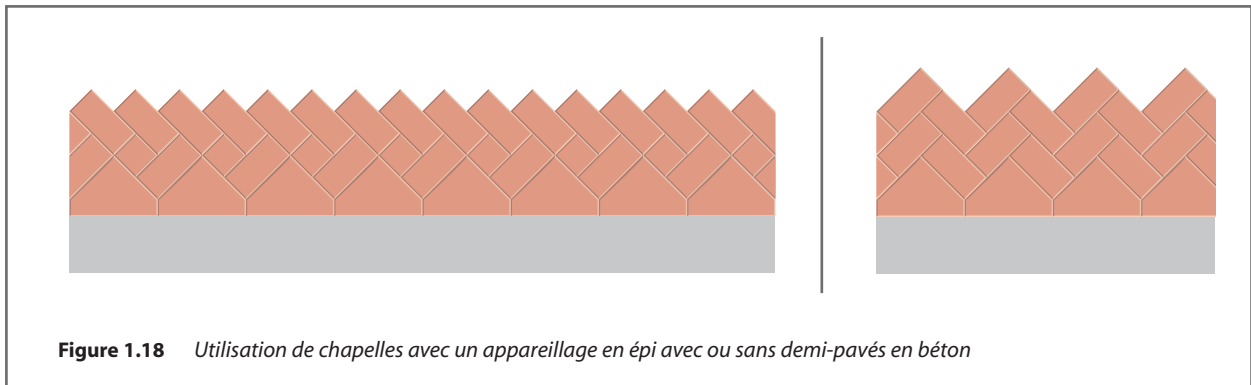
Utilisation de chapelles avec un appareillage en épi avec ou sans demi-pavés en béton
